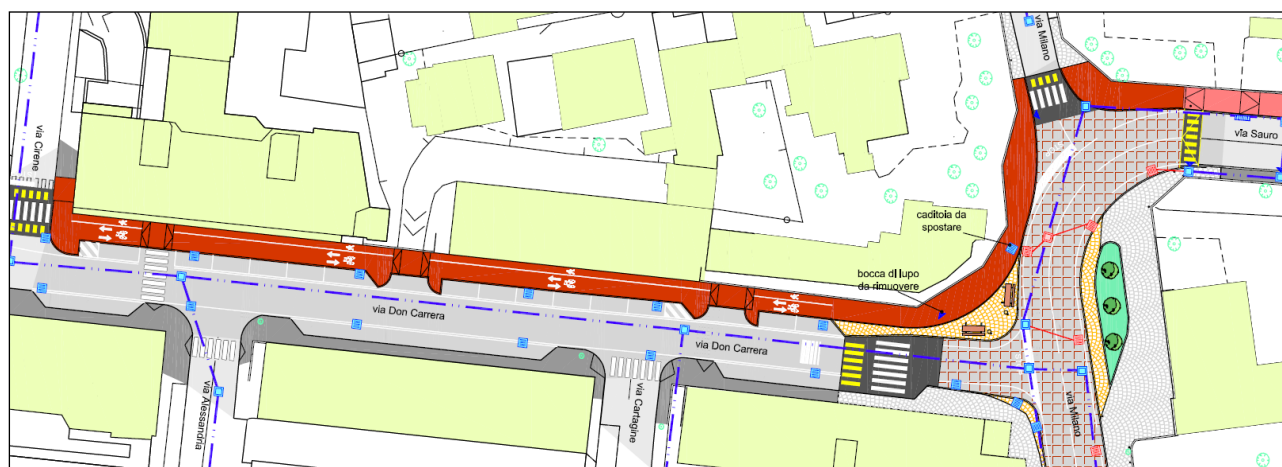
Planimetria con illuminazione pubblica di progetto e relativa legenda
